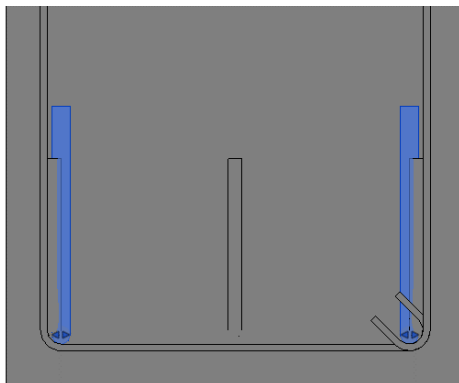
Exemplo de sobreposição de varões longitudinais em vigas (corte transversal da peça)
